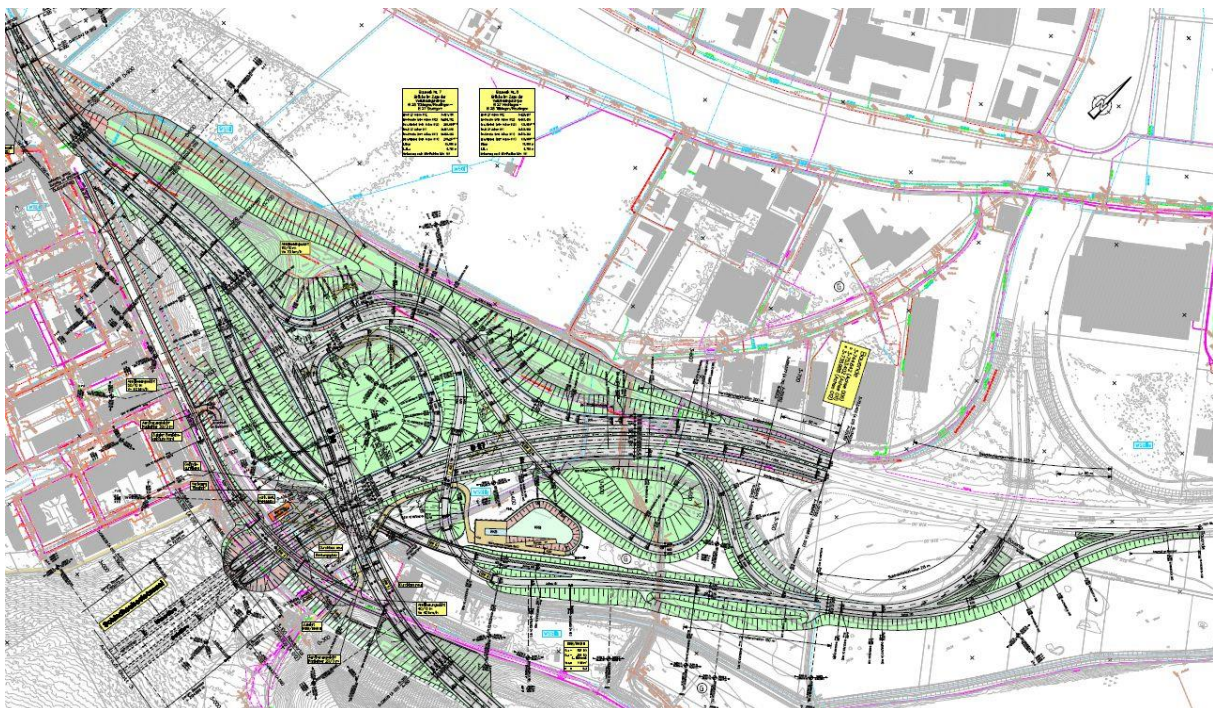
Lageplan Tübinger Kreuz – Einfachanschluss (II/3Br)
